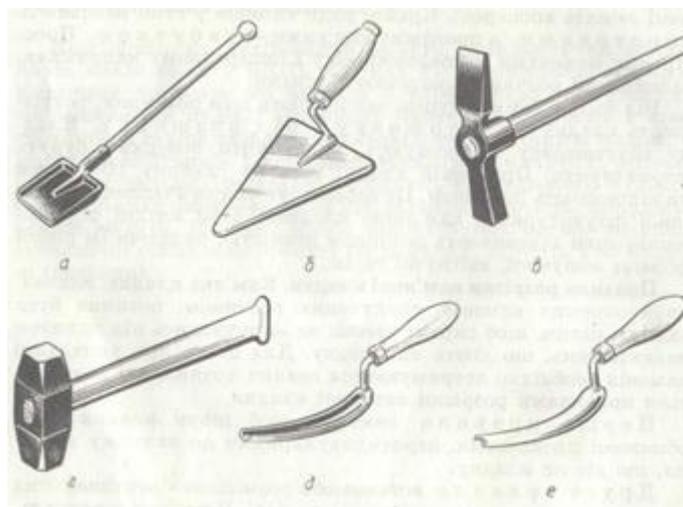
Виробничі інструменти для кам'яної кладки: а — лопата для розчину; б — кельма; в — молоток-кирочка; г — молоток-кулачок; д — ввігнута й е — опукла розшивки
